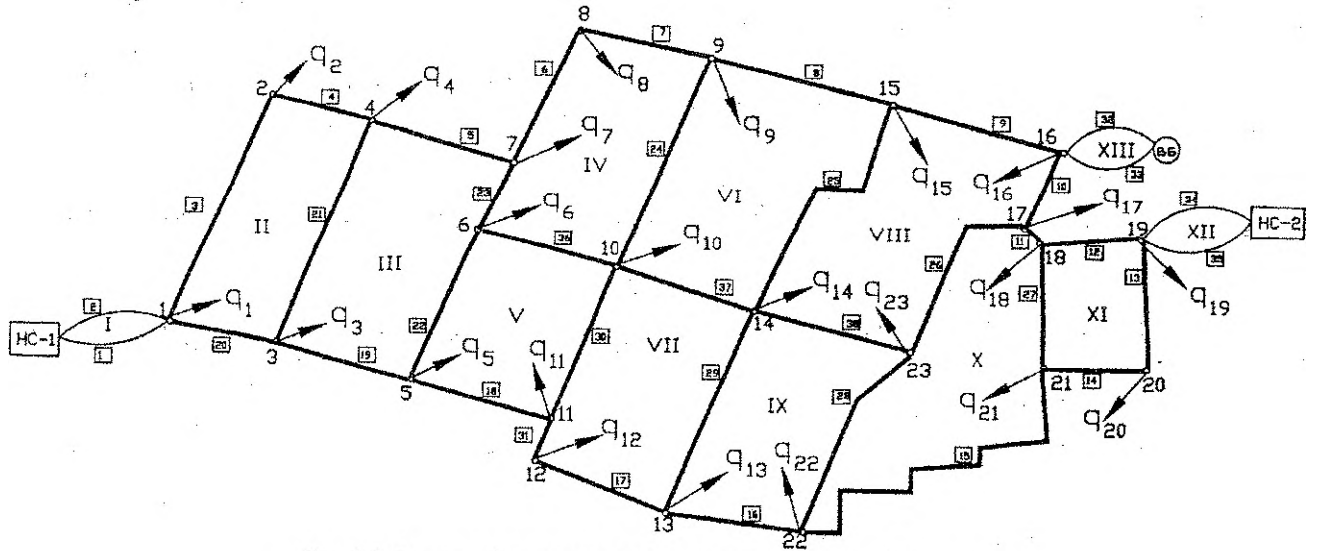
Расчетная схема водопроводной сети I очереди строительства
